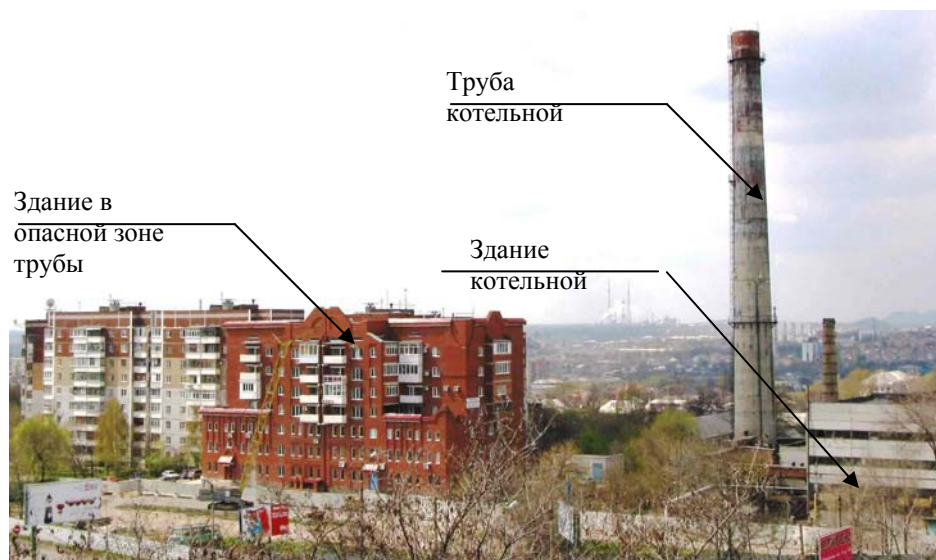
Высокая железобетонная дымовая трубы котельной.
